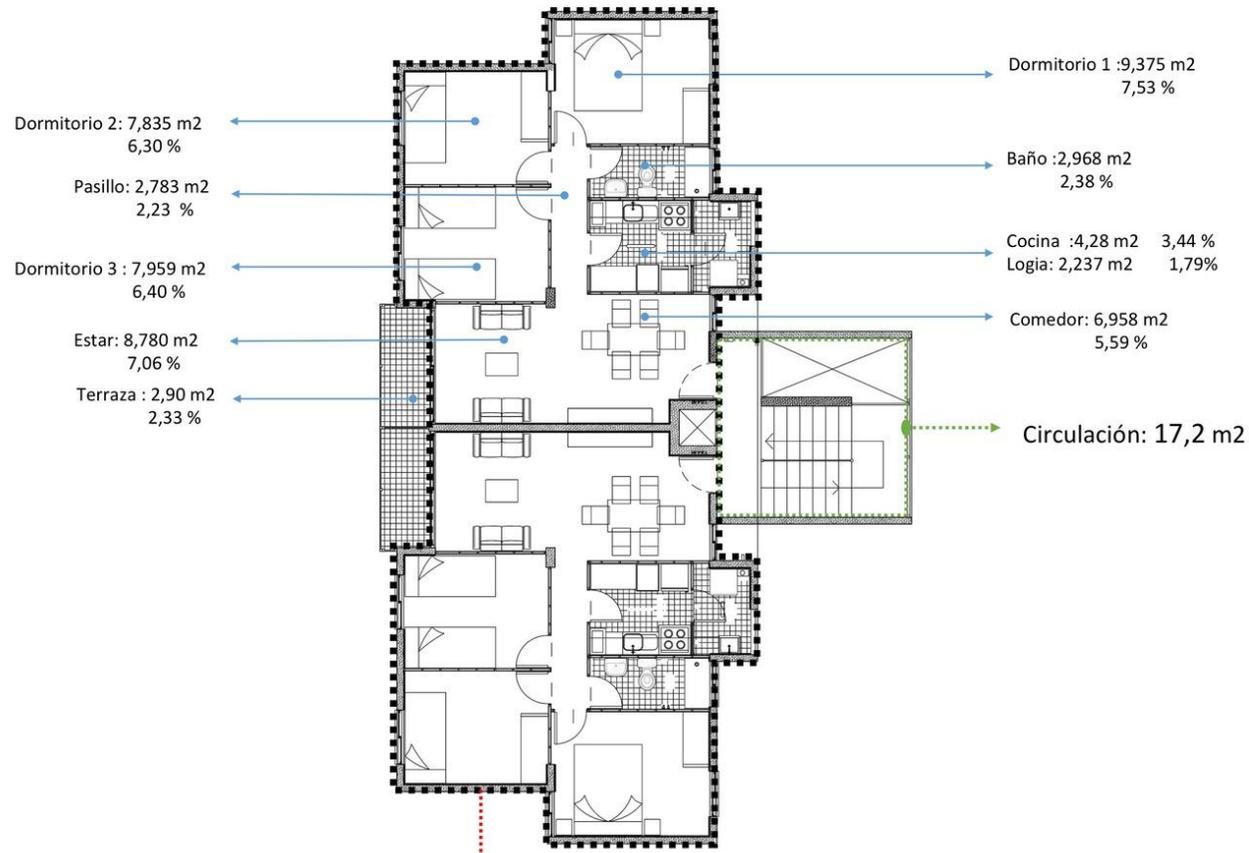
Planta Tipo → Total x nivel: 124,34 m²
